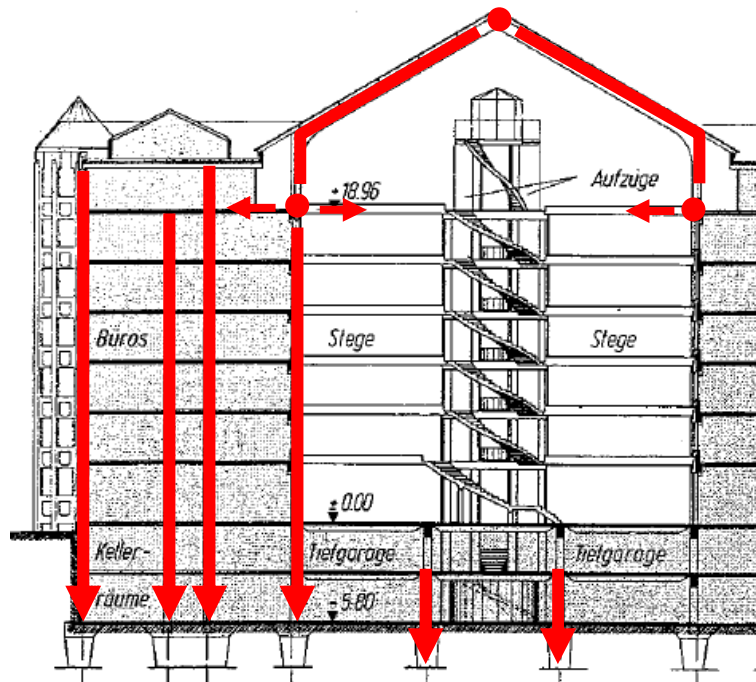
Vertikallastableitung Vertikallastableitung<sup>1</sup>
